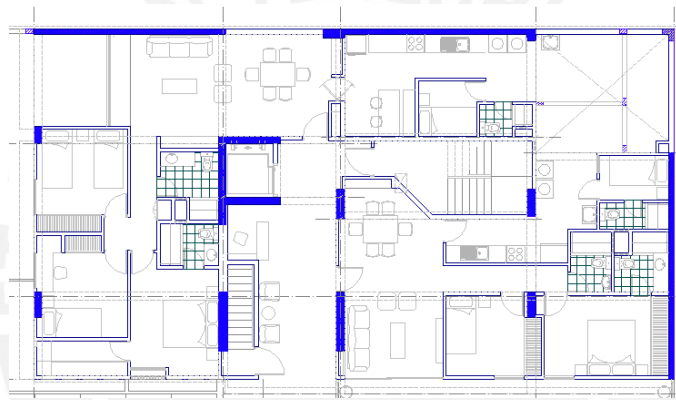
Compatibilización de Ubicación de Columnas y Placas en Planta de Arquitectura.
